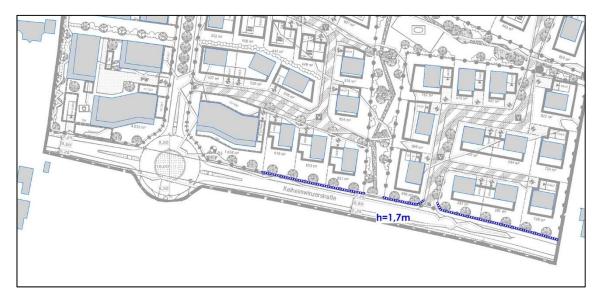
Lageplan mit Darstellung der Lärmschutzanlagen entlang der Kelheimwinzerstraße
